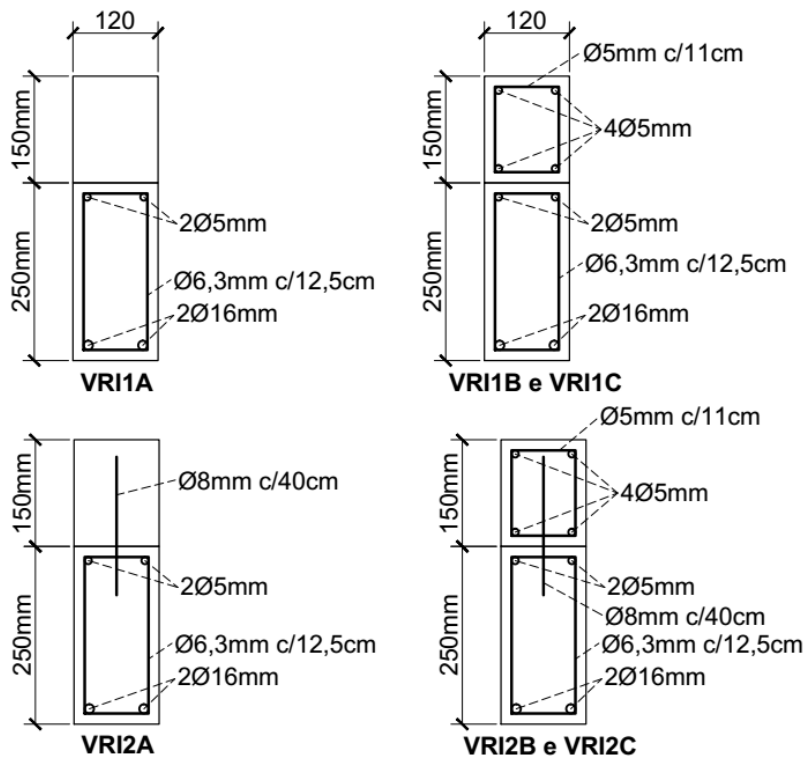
Detalhamento das vigas da segunda série (SILVA, 2011).
